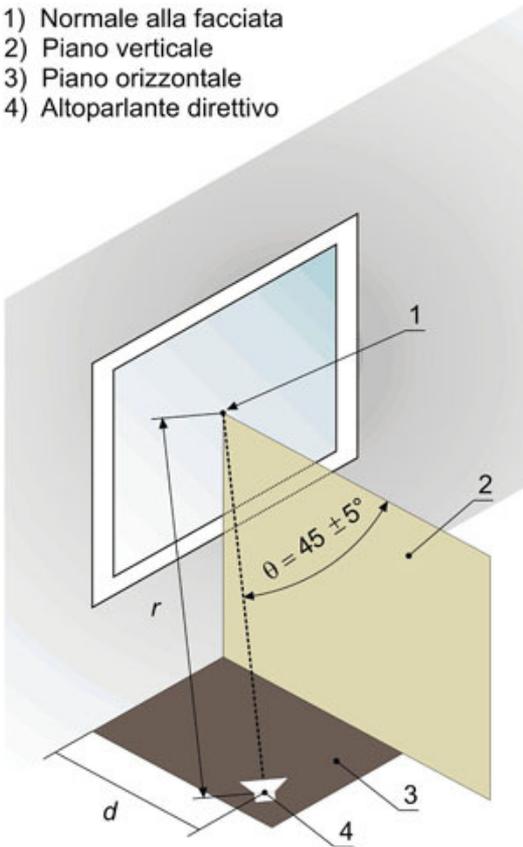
Disposizione dell'altoparlante rispetto alla facciata.
